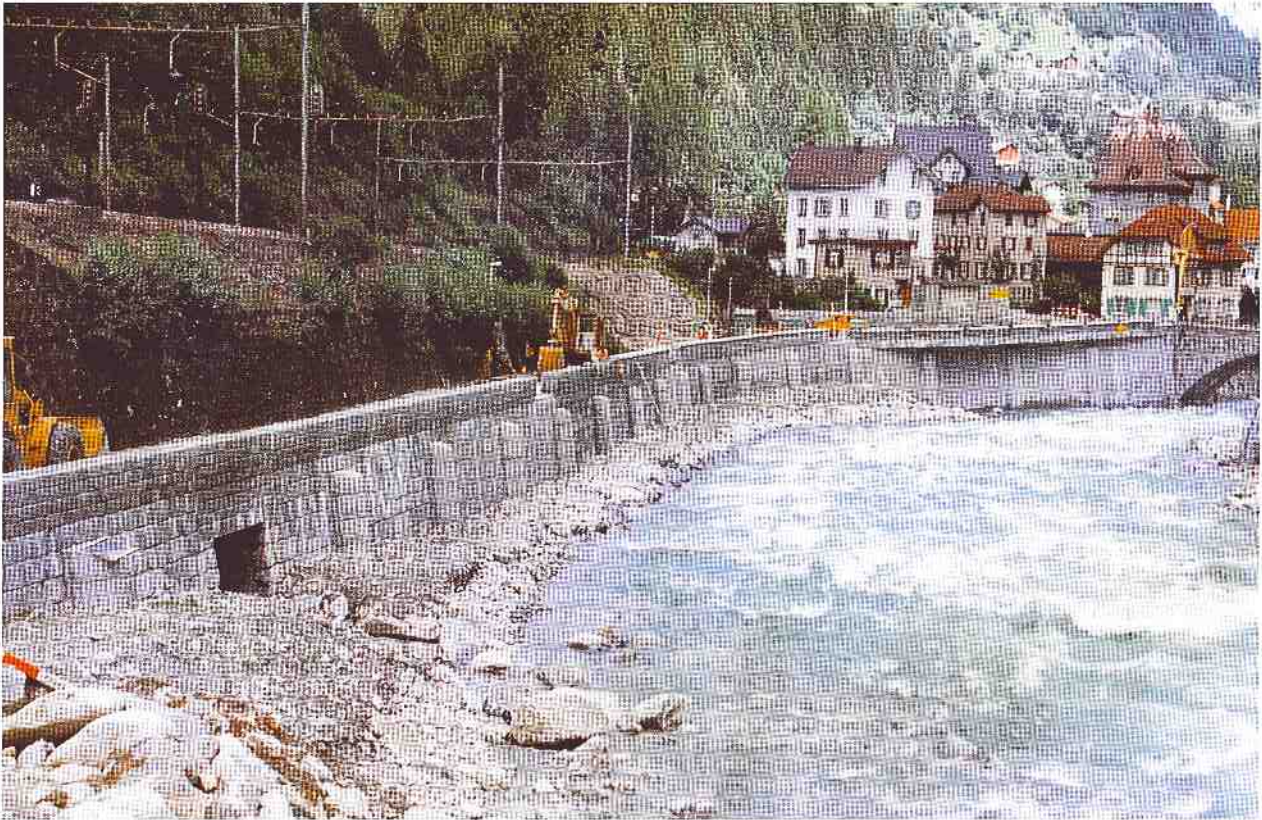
Hauptschutzelement C: Bruchsteinverkleidete Ufermauer oberhalb der Wilerbrücke.
